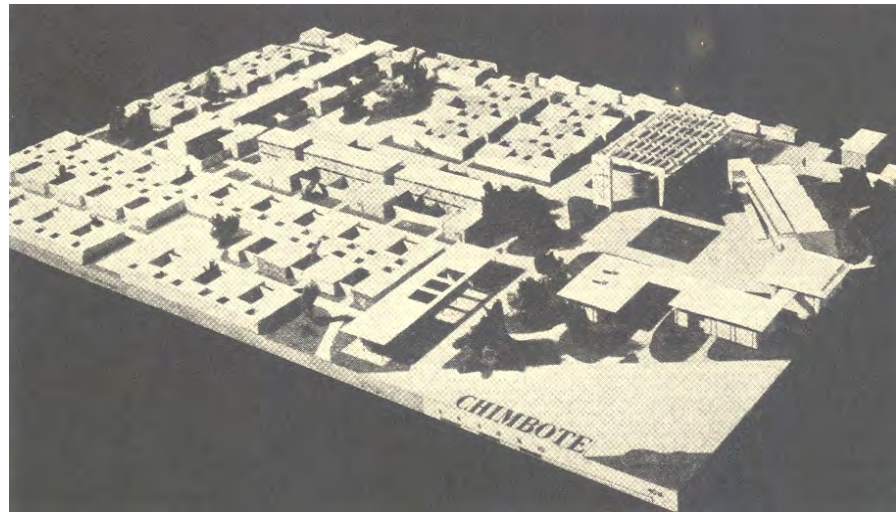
Plan Piloto de Chimbote. Unidad Vecinal.
